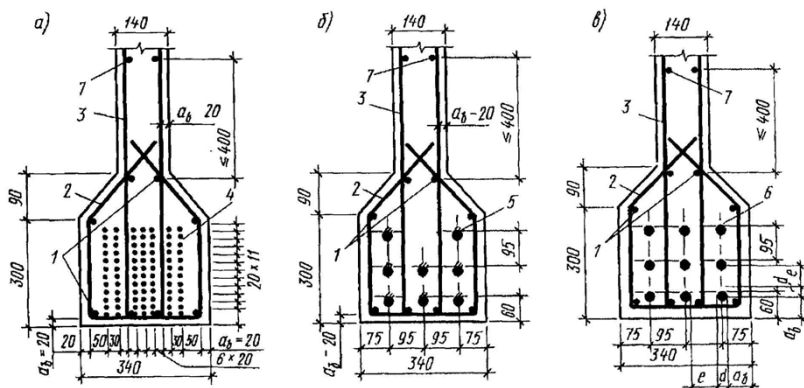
Примеры армирования растянутой зоны тавровых балок: *а* – отдельными напрягаемыми проволоками; *б* – напрягаемыми стержнями; *в* – напрягаемыми канатами; 1 – продольная монтажная ненапрягаемая арматура; 2 – хомуты, охватывающие напрягаемую арматуру; 3 – поперечная арматура балки; 4 – напрягаемая высокопрочная проволока; 5 – напрягаемая стержневая арматура; 6 – напрягаемые канаты; 7 – конструктивная противоусадочная продольная арматура
